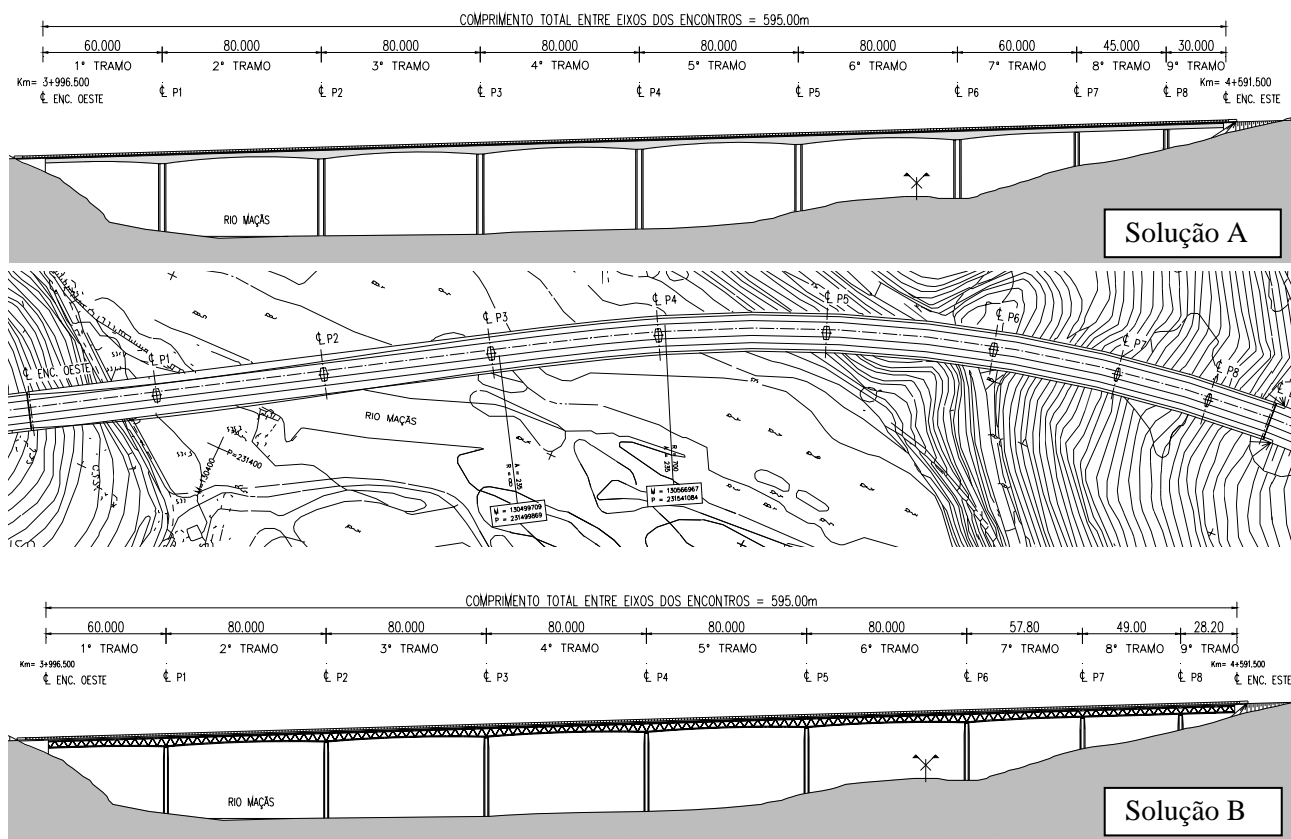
Alçado e planta das soluções apresentadas na fase de Estudo Prévio
